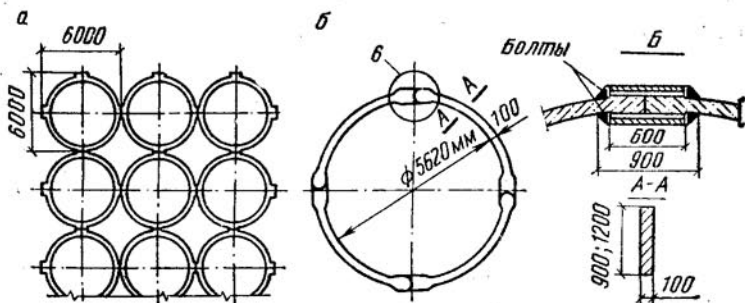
Сборные силосные корпуса с цилиндрическими силосами
